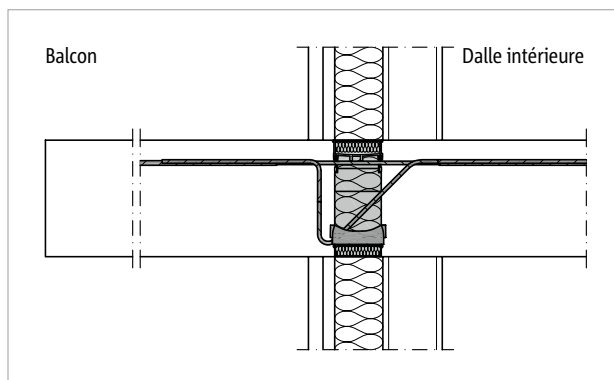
Schöck Isokorb® T Type CK : balcon avec mur à charpente d'acier, isolation des cavités et bardage de la façade
